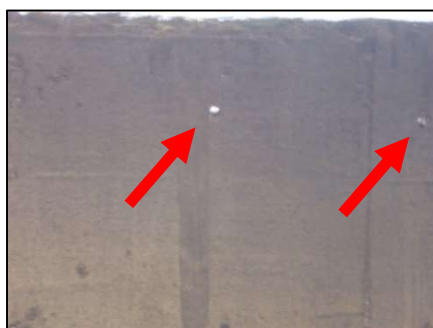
Situação desfavorável executada na obra. Furo para passagem das agulhas não foi tapado.
